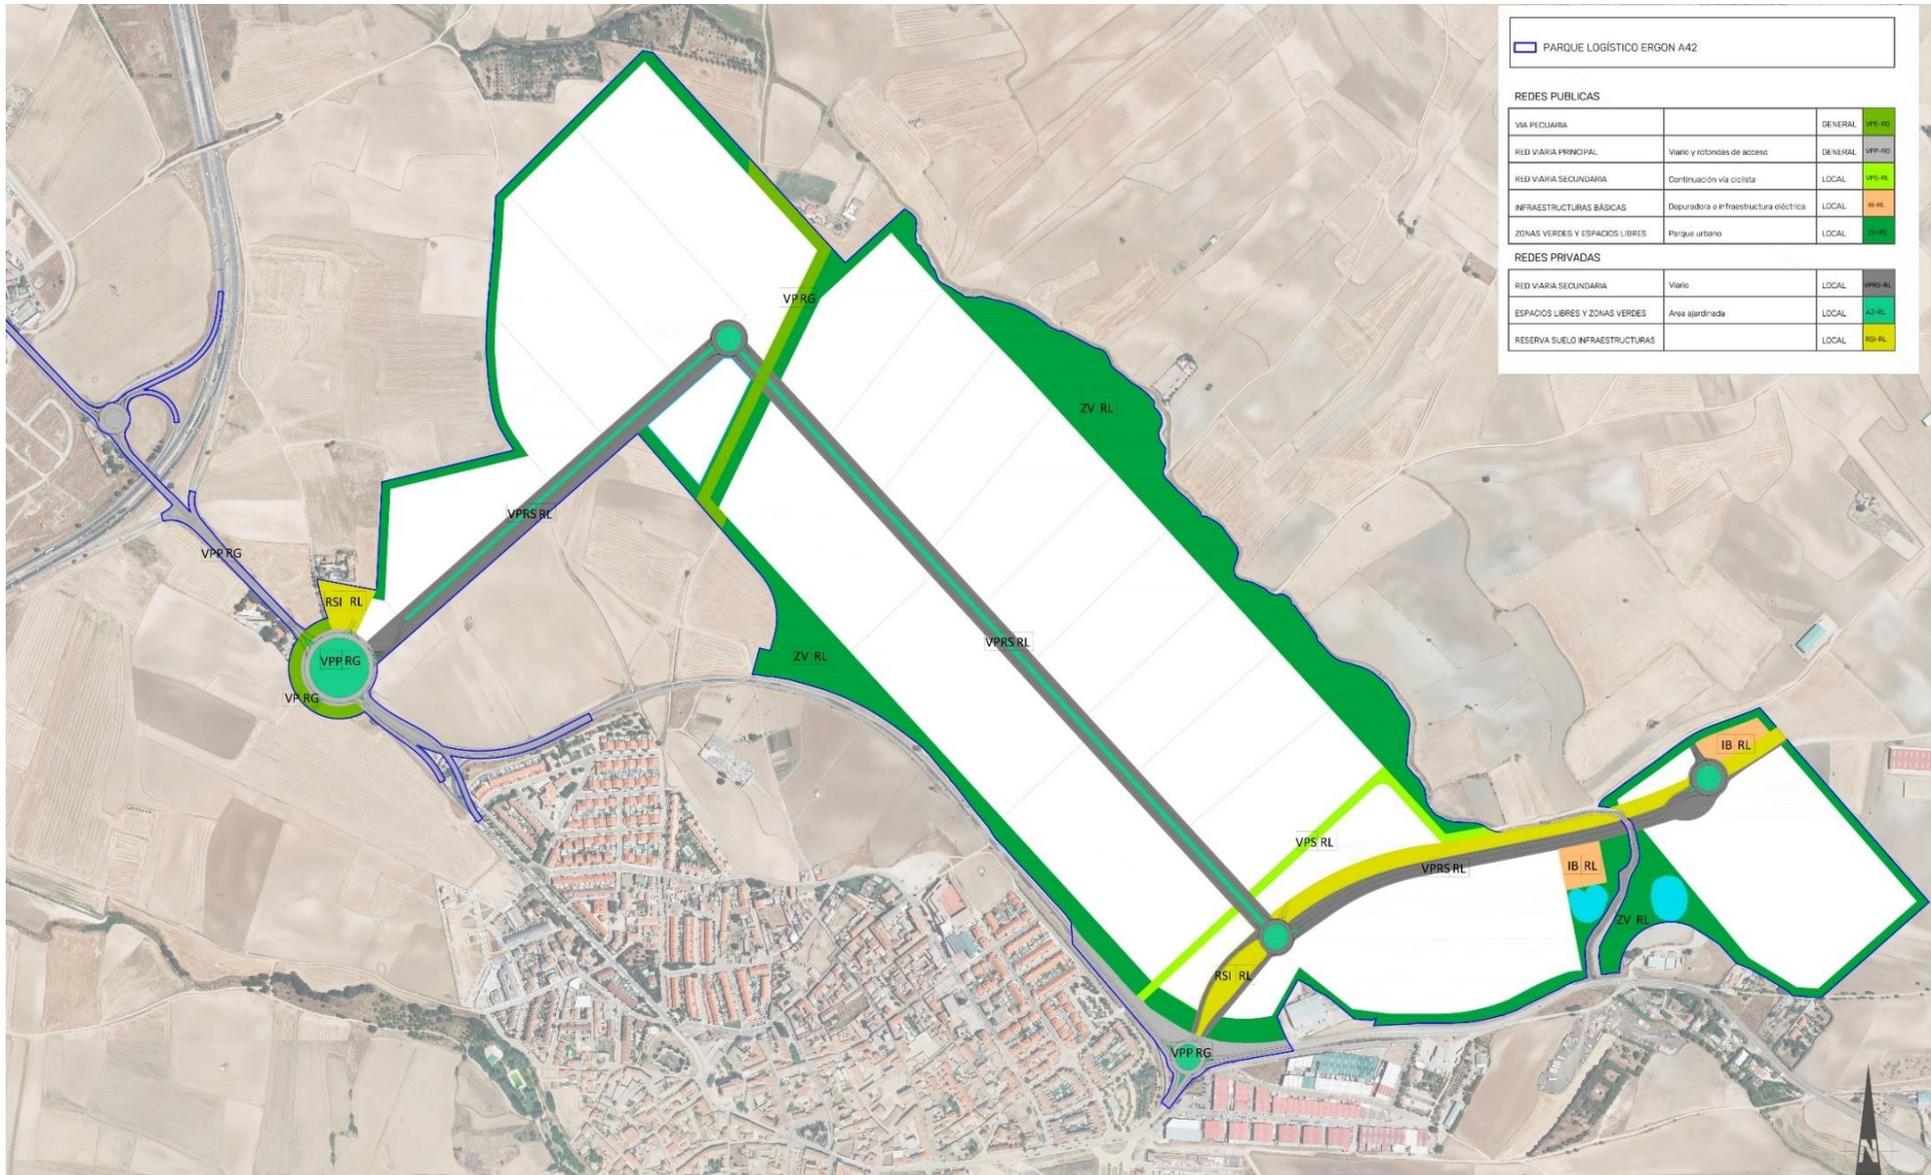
Plano de Ordenación O-4 Redes. Fuente: Elaboración propia
